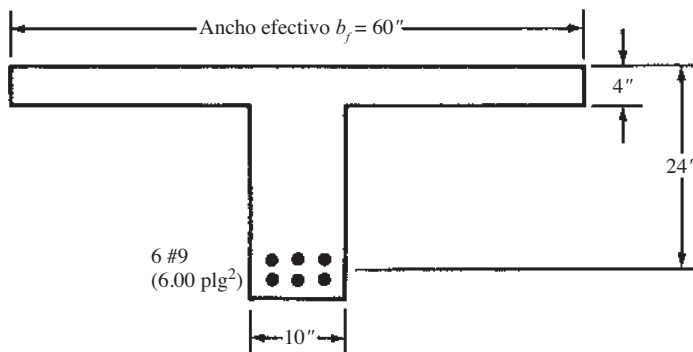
Sección transversal de la viga del Ejemplo 5.1.
